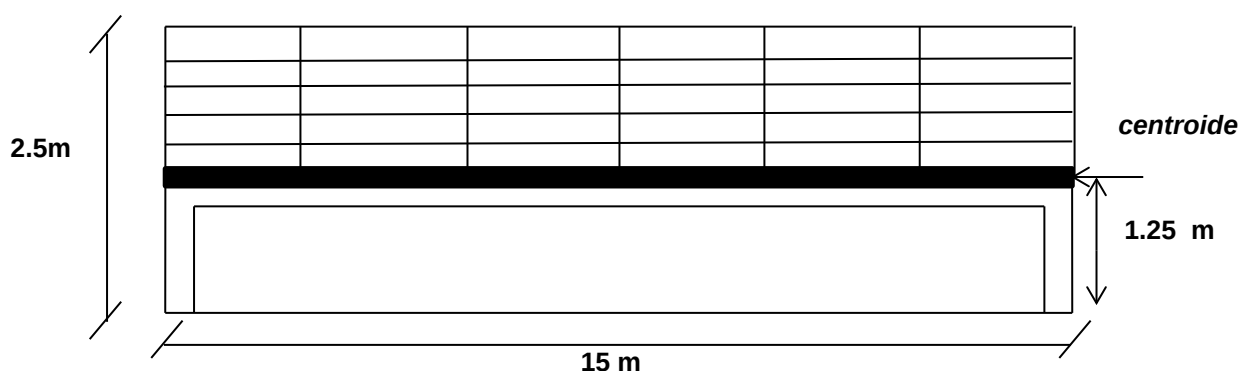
Altura de la sección longitudinal del puente y su centroide.
